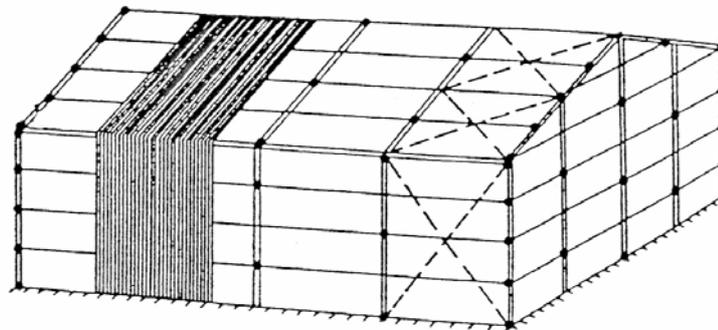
Elementos estruturais de um edifício industrial, com contraventamento na zona inferior da asna (por efeito da acção horizontal do vento, quando provoca sucção na cobertura)
